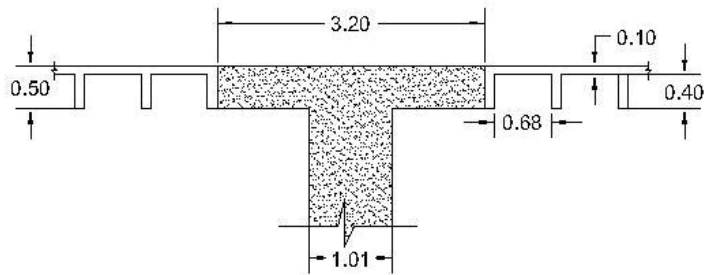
Corte da estrutura dimensionada. Laje nervurada protendida associada a viga-faixa.
